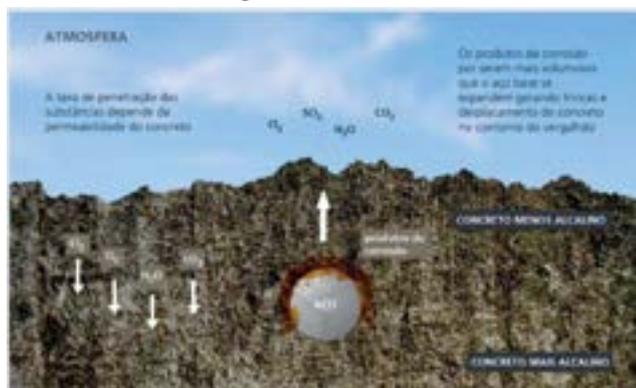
Penetração de elementos corrosivos no concreto
